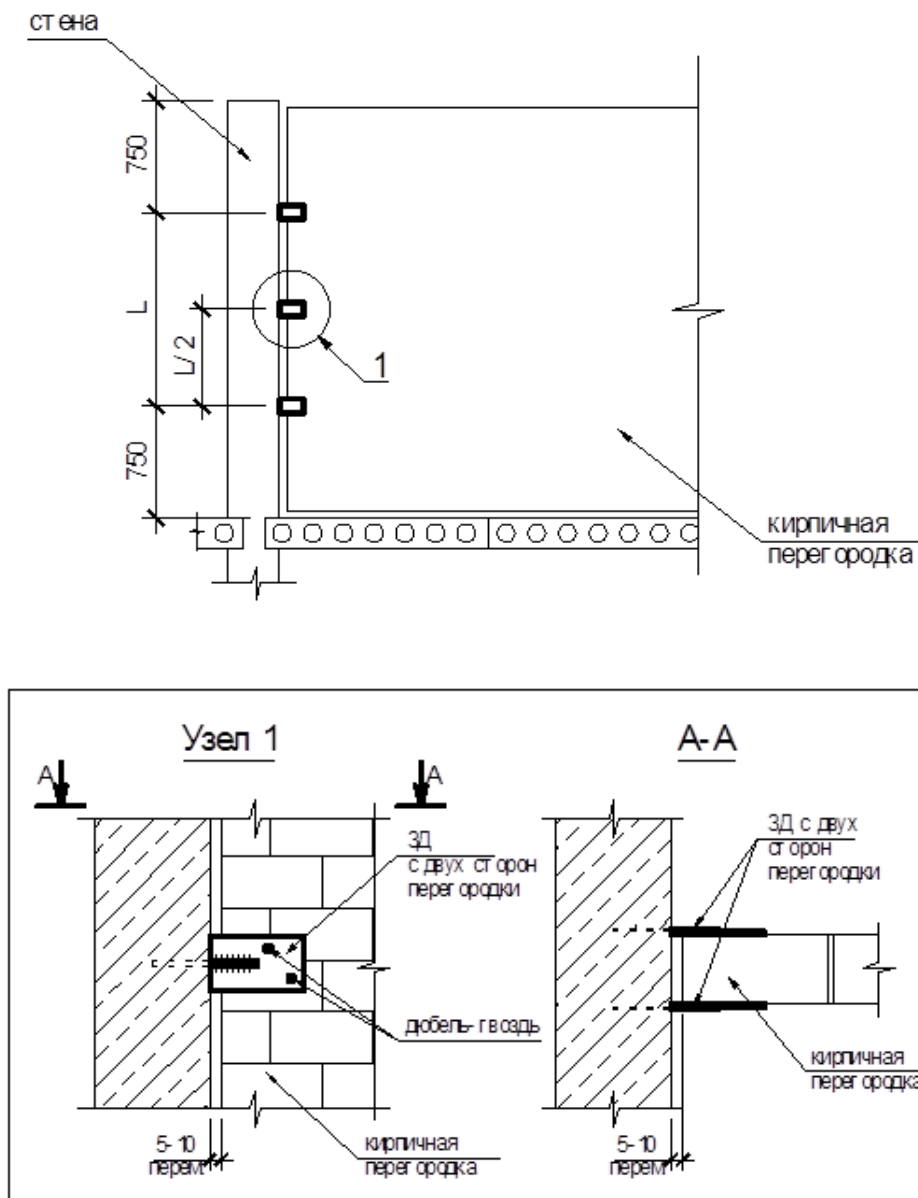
Схема крепления перегородок в местах сопряжения с капитальными стенами закладными деталями.
